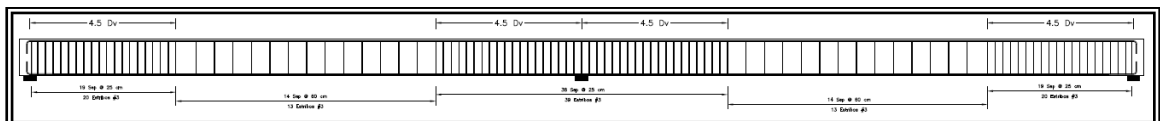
80 Distribución del refuerzo transversal para la viga longitudinal.
